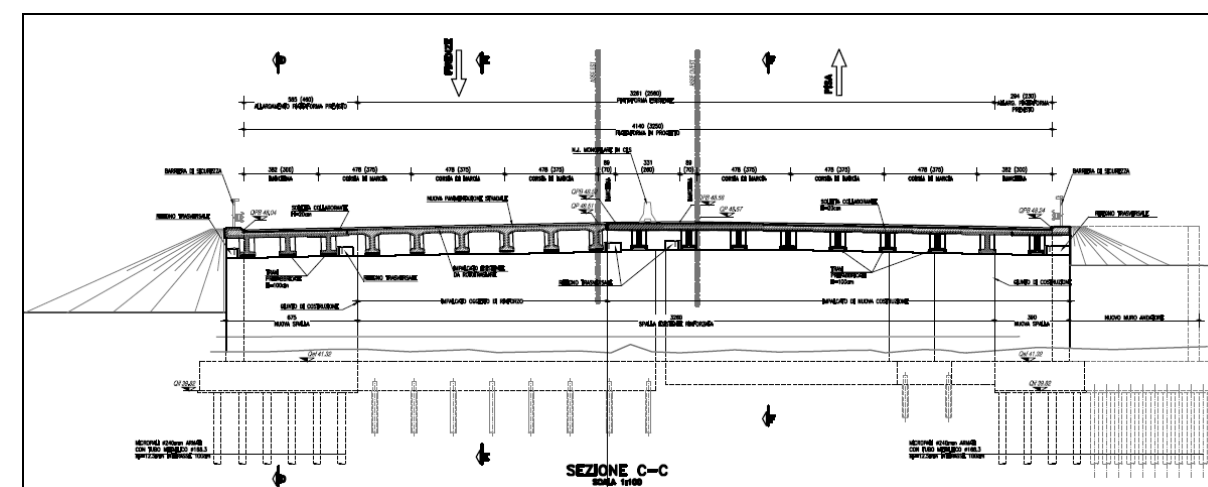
Ponte sul T. Marina. Sezione trasversale.
